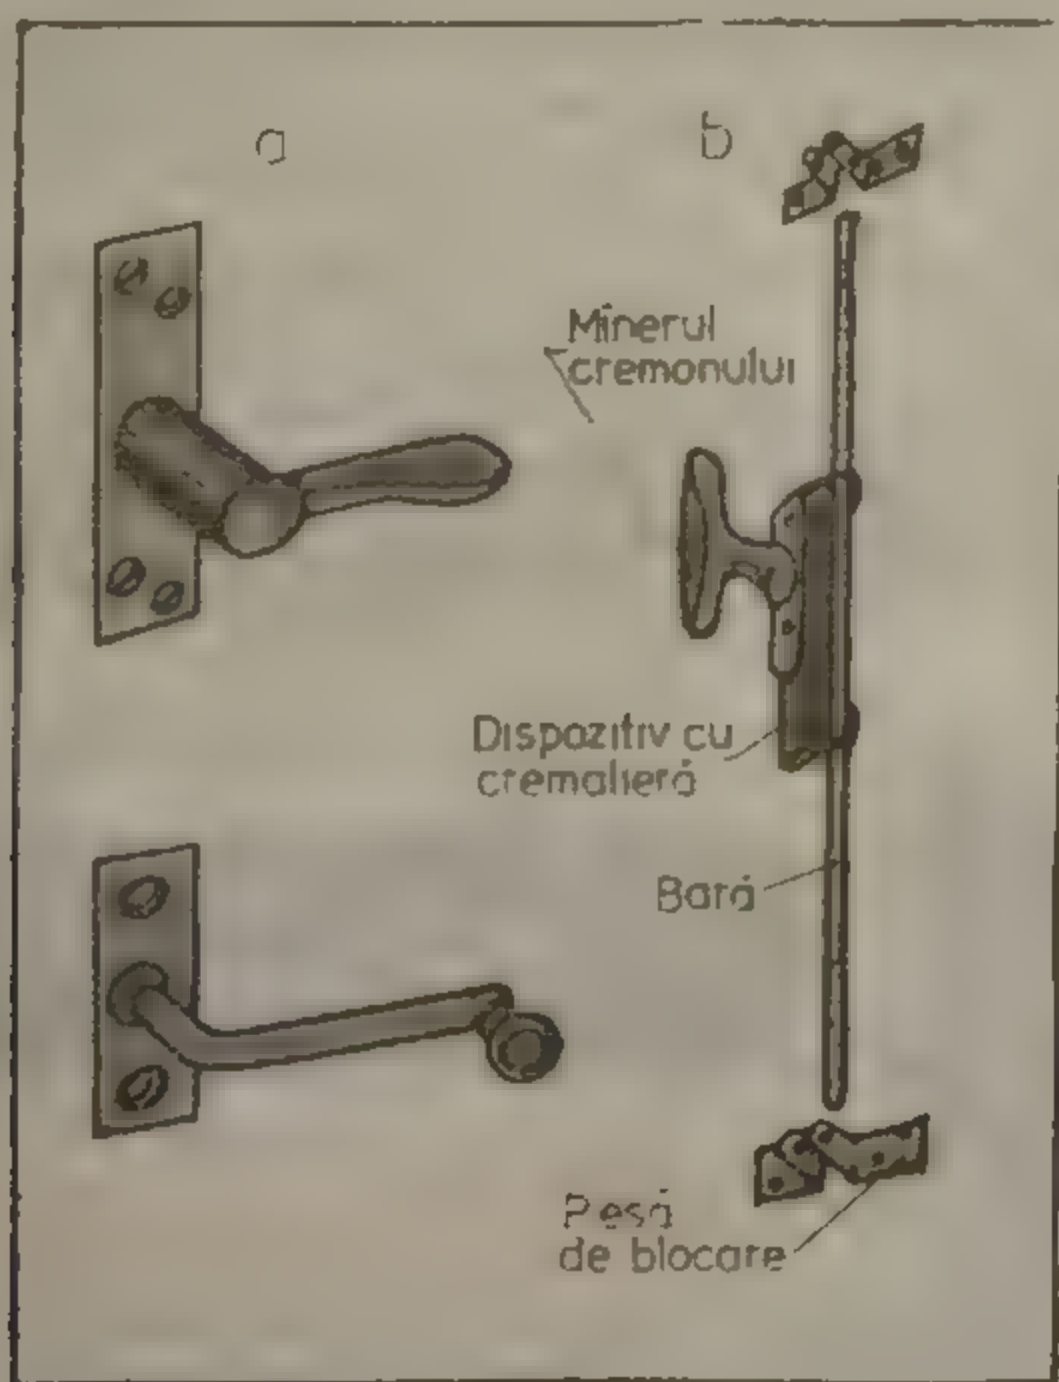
Inchizătoare pentru ferestre și uși.
